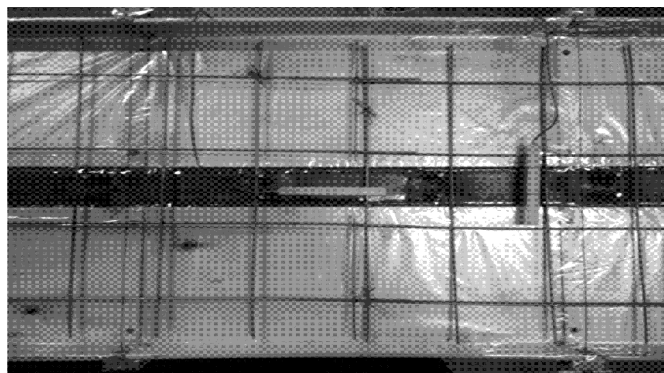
Датчики деформаций бетона до укладки бетонной смеси
